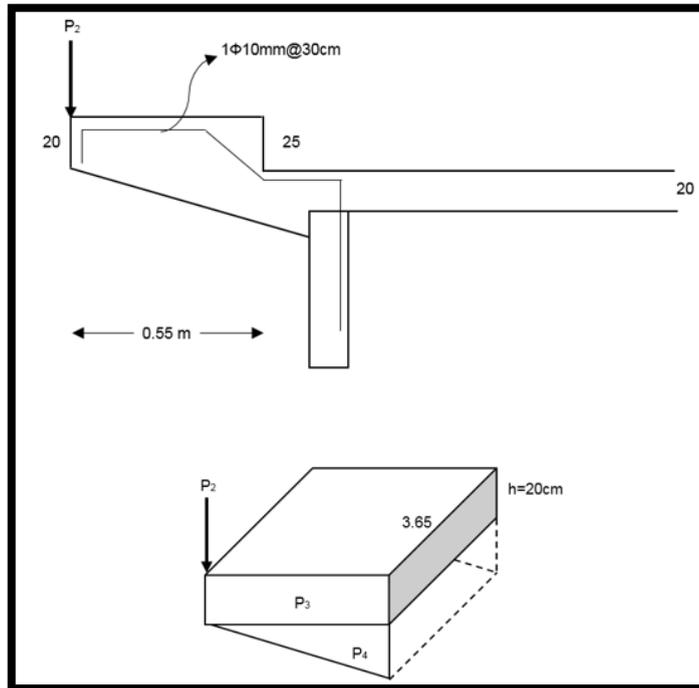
Armado del acero longitudinal de la losa de rodadura
